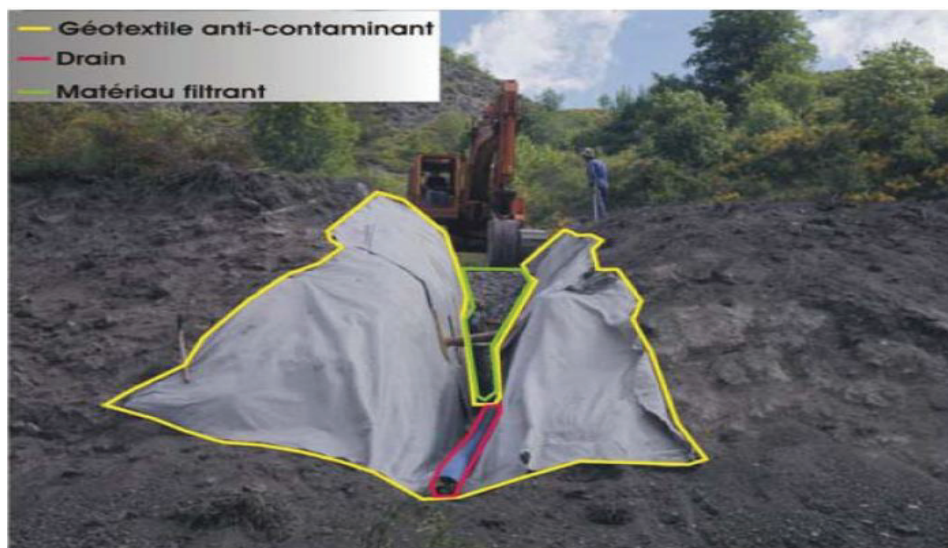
Travaux de mise en place d'une tranchée drainante sur le glissement de Ciastel (Alpes-Maritimes) [S11].
